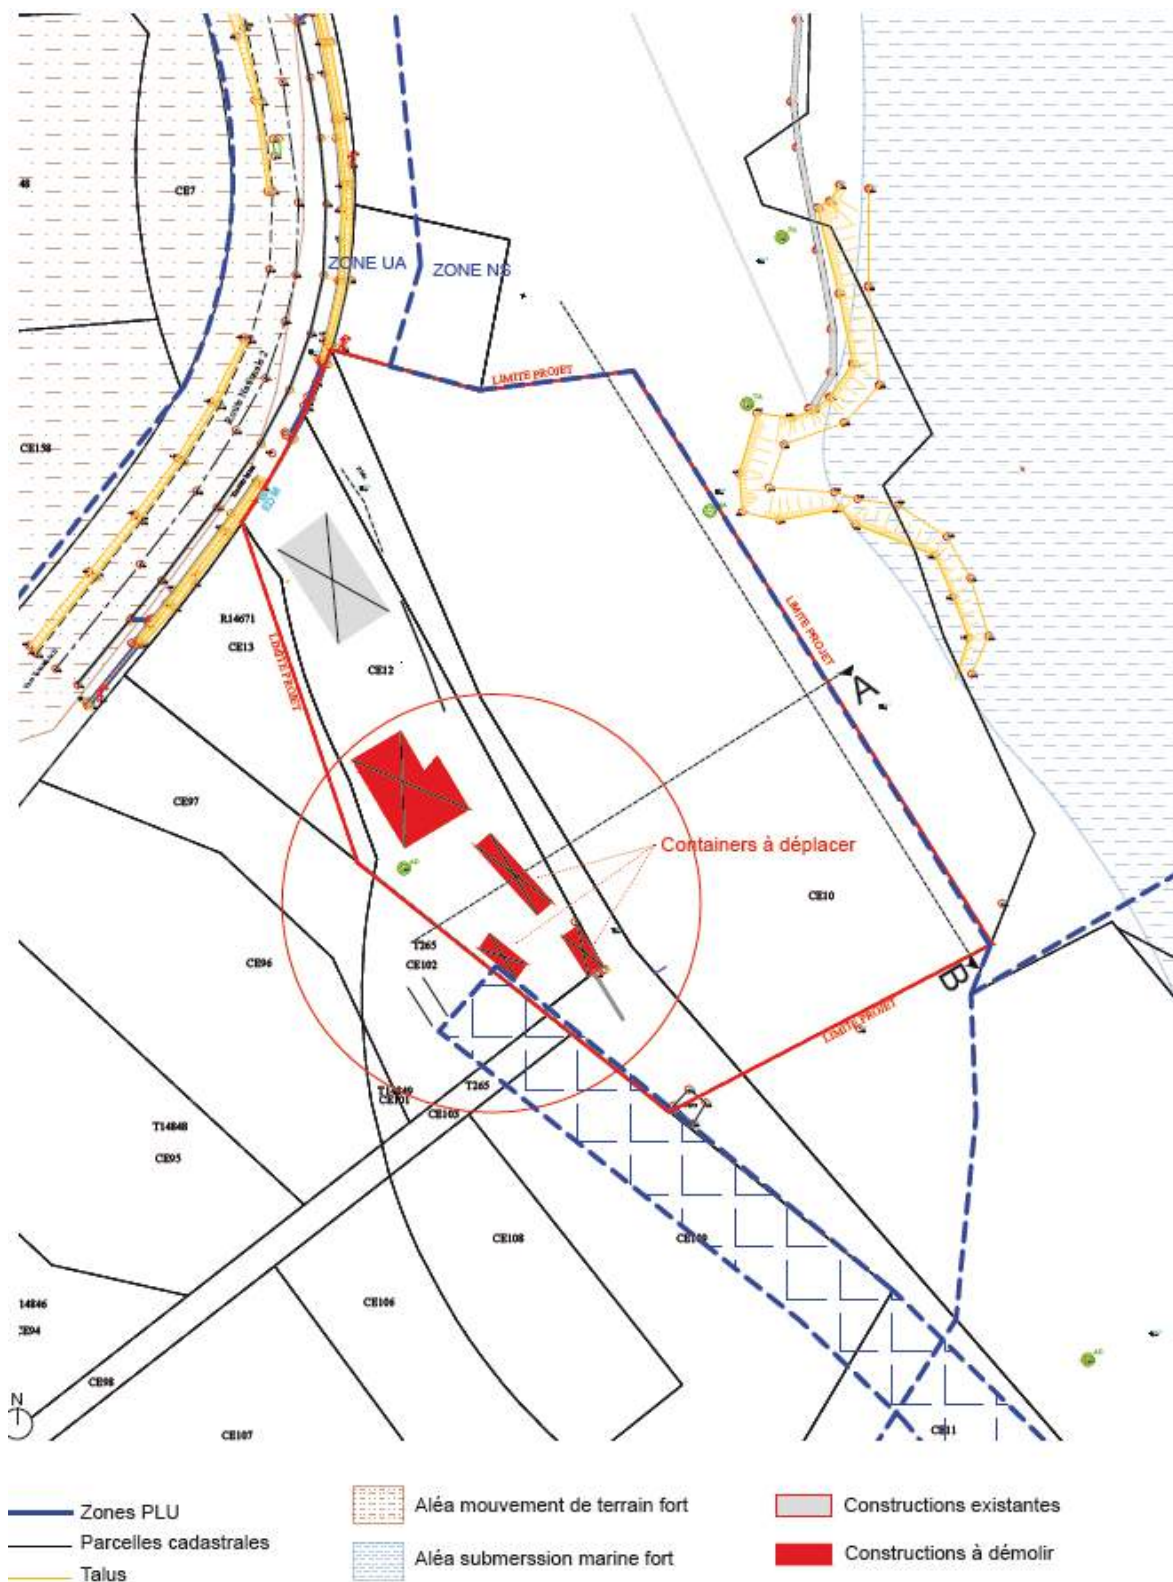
Plan des démolitions prévues sur site (Source : HARAPPA 2020)
